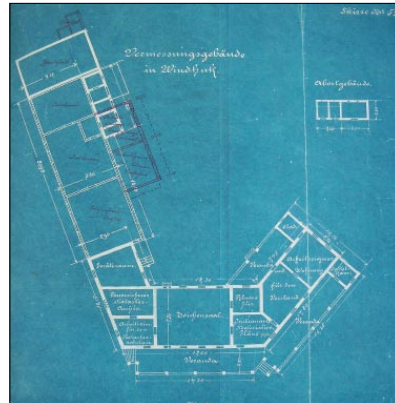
Grundriß der Kaiserlichen Landesvermessung, 1909, mehrmalige Erweiterungen (NNA, BAU-38 LV-Wdh)
